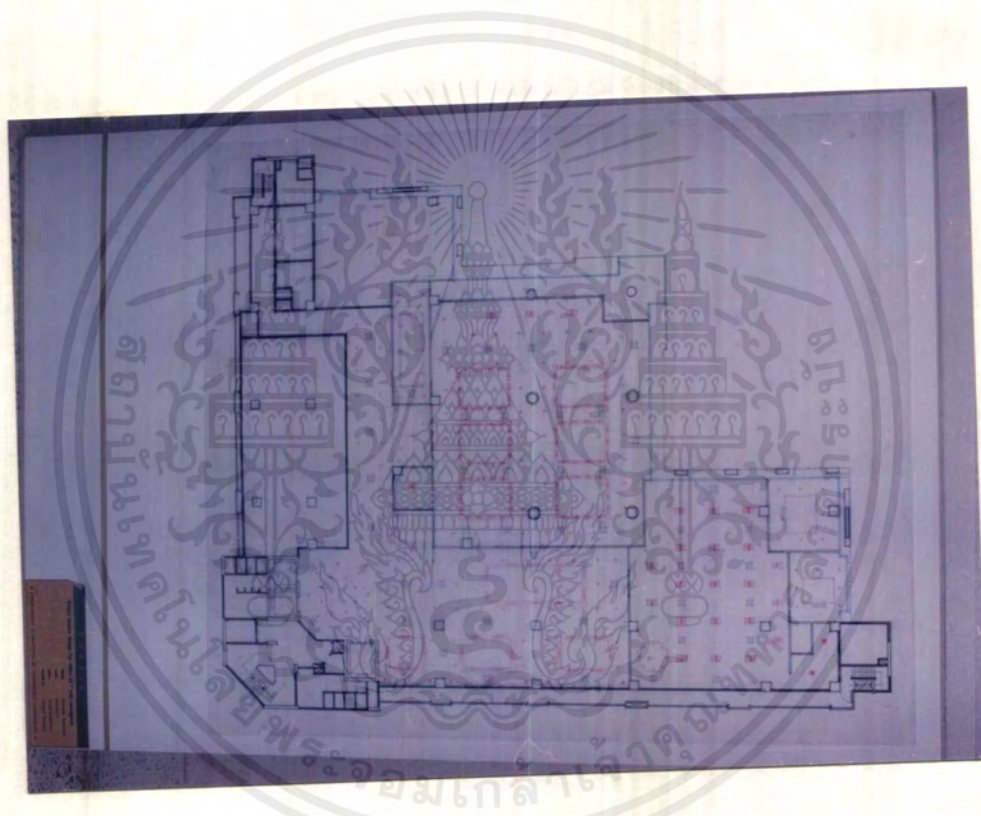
LIGHTING LAY-OUT SECOND FLOOR PLAN
